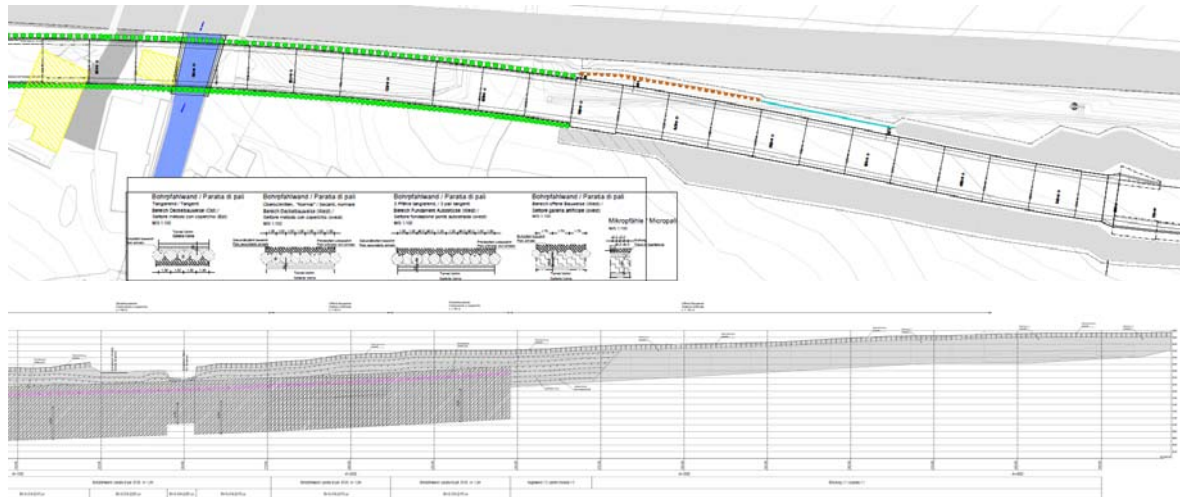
Lageplan und Längsschnitt Tunnel Vahrn
